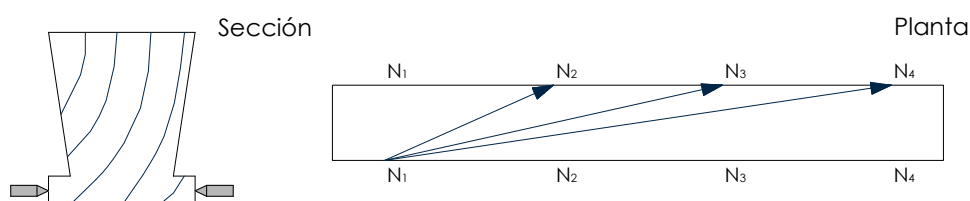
Mediciones longitudinales cruzadas realizadas en la sección exterior de las vigas.
